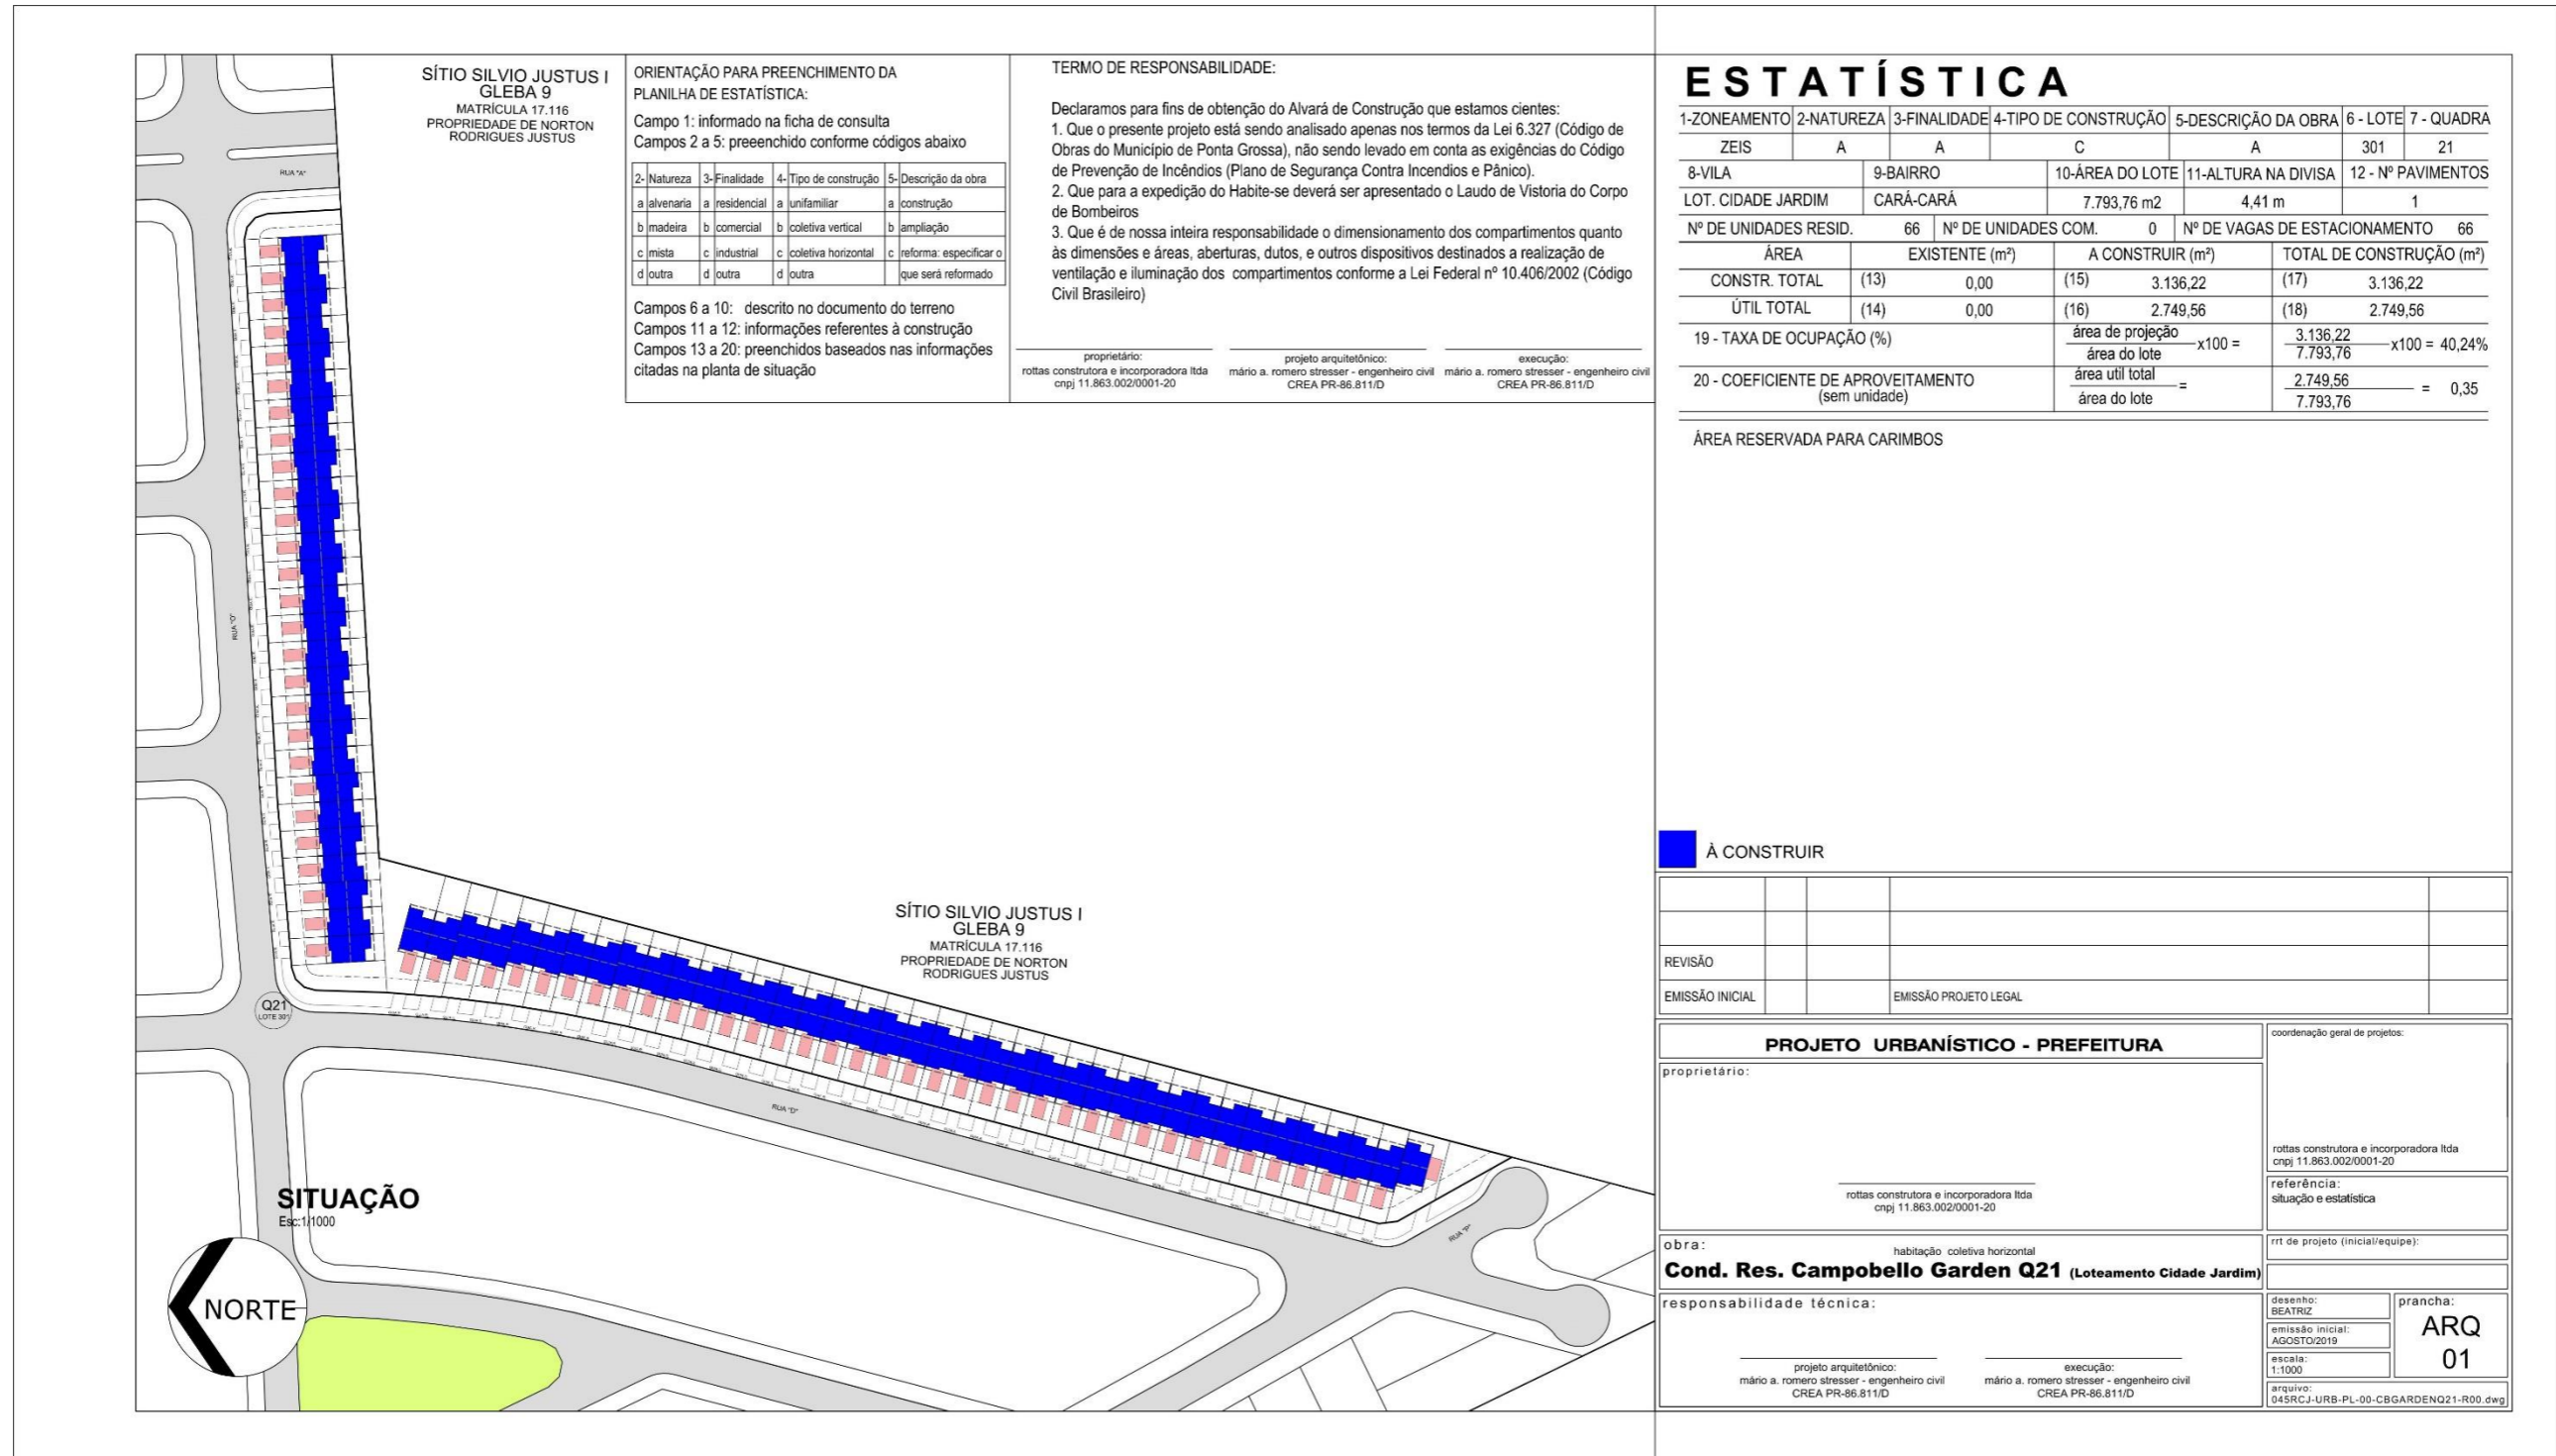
Projeto Urbanístico – Planta de Situação da Quadra 21 (Prancha 01).
